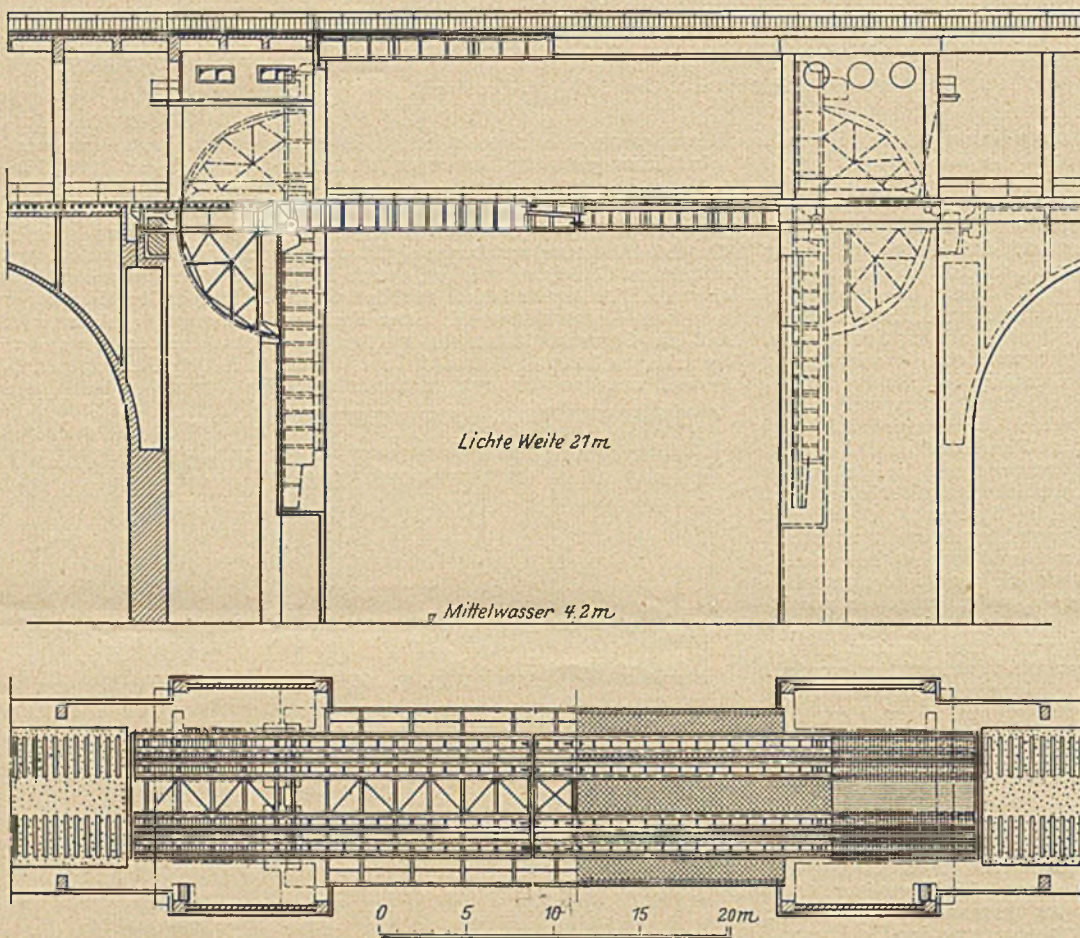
Durchfahrtöffnung im nördlichen Sunde. Längenschnitt, Ansicht, wagerechter Schnitt und Draufsicht.
